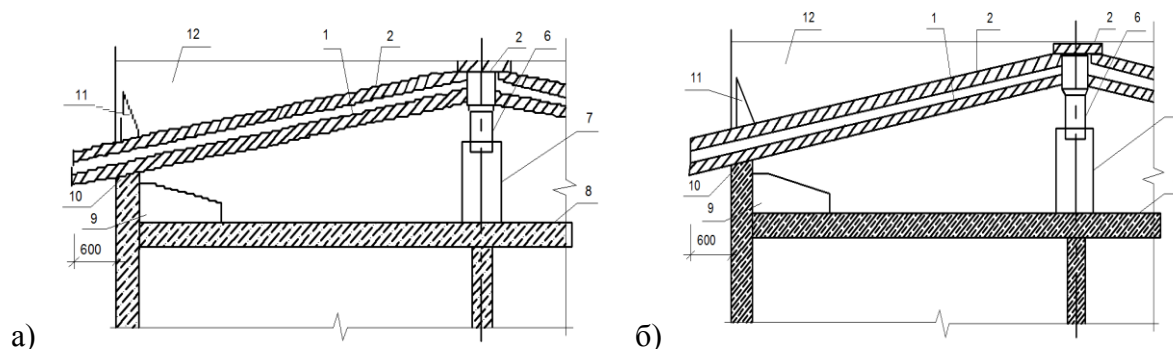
Конструктивные схемы кровли из железобетонных лотковых панелей
